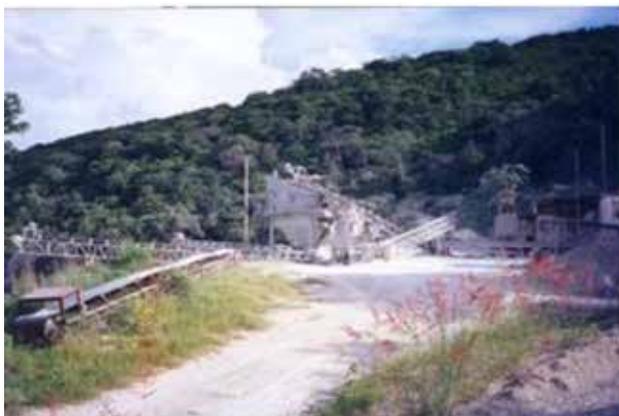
Banco PROTSA donde extrae grava y arena para la industria de la construcción, ubicado al suroeste de Tuxtla Gutiérrez.
